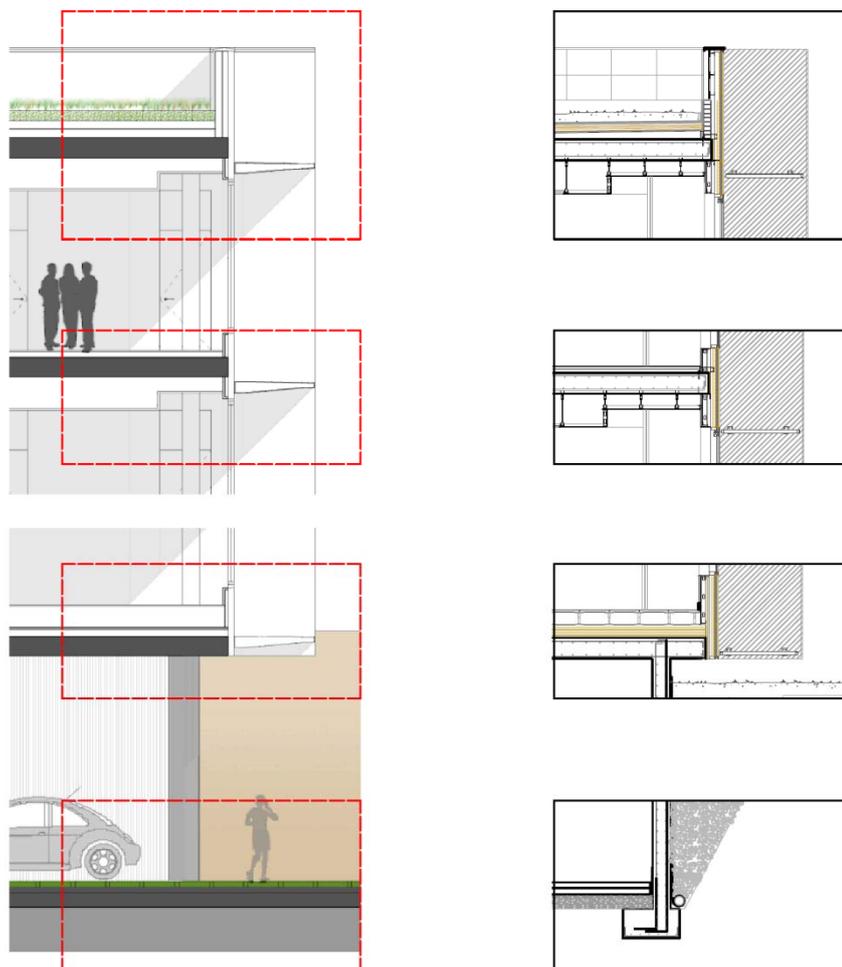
Detalle constructivo de la continuidad de aislamiento y carpintería para evitar puentes térmicos
